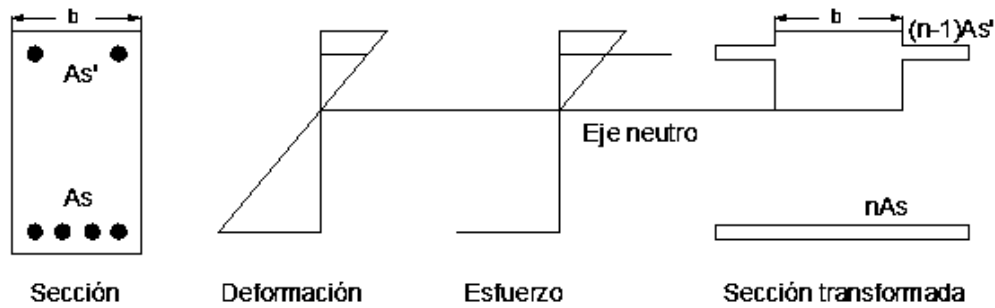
Sección transformada para flexión después del agrietamiento (Park and Paulay, 1983)
